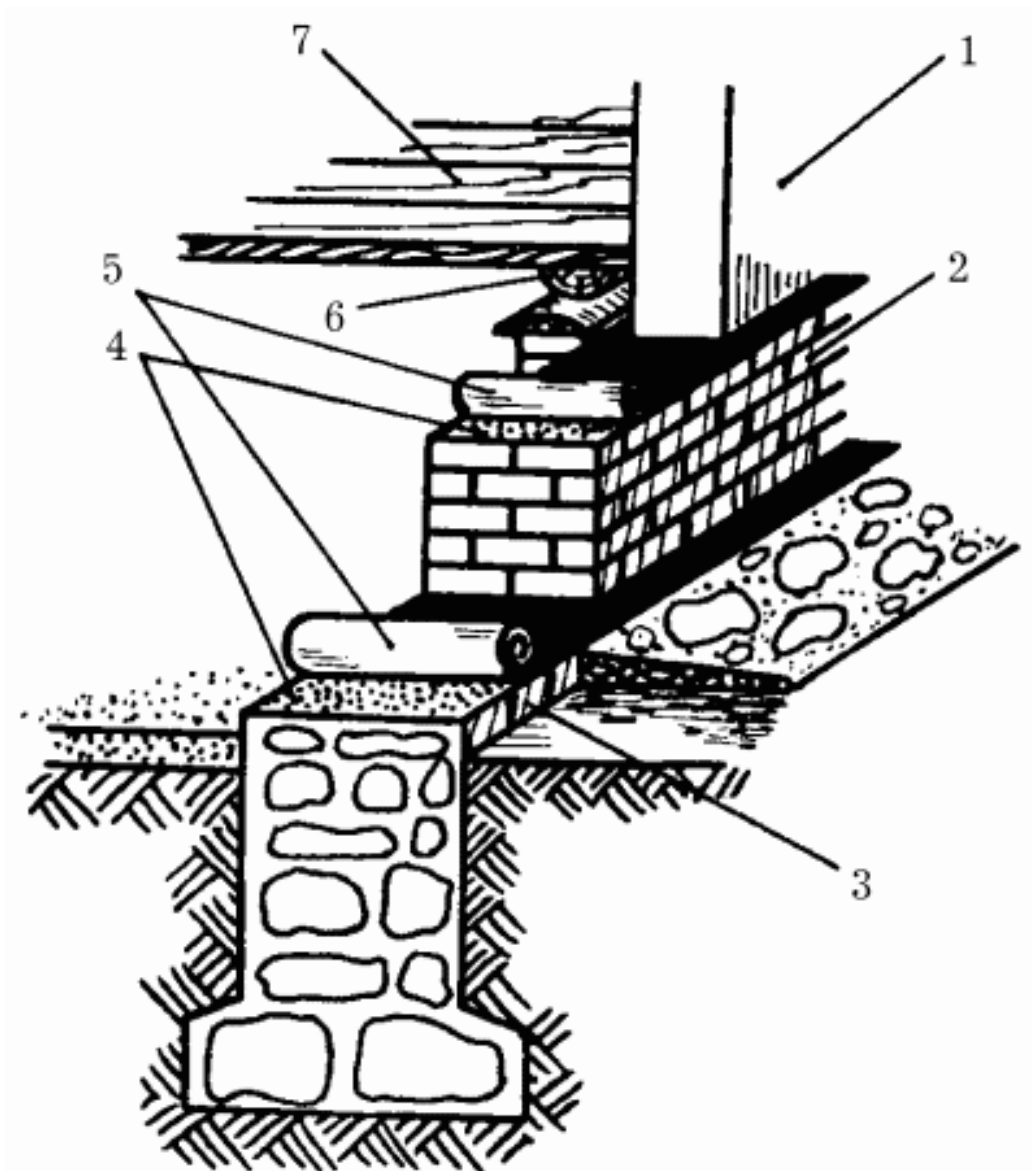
Ленточный фундамент: 1 – стена; 2 – цоколь; 3 – отмостка; 4 – раствор цемента; 5 – гидроизоляционный материал; 6 – лага; 7 – пол.
